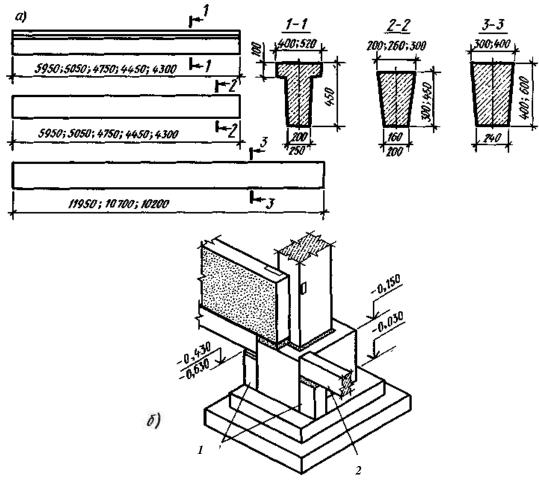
Детали фундаментов крайнего ряда колонн: а — типы фундаментных балок; б — детали; 1 — железобетонные столбики; 2 — фундаментная балка
